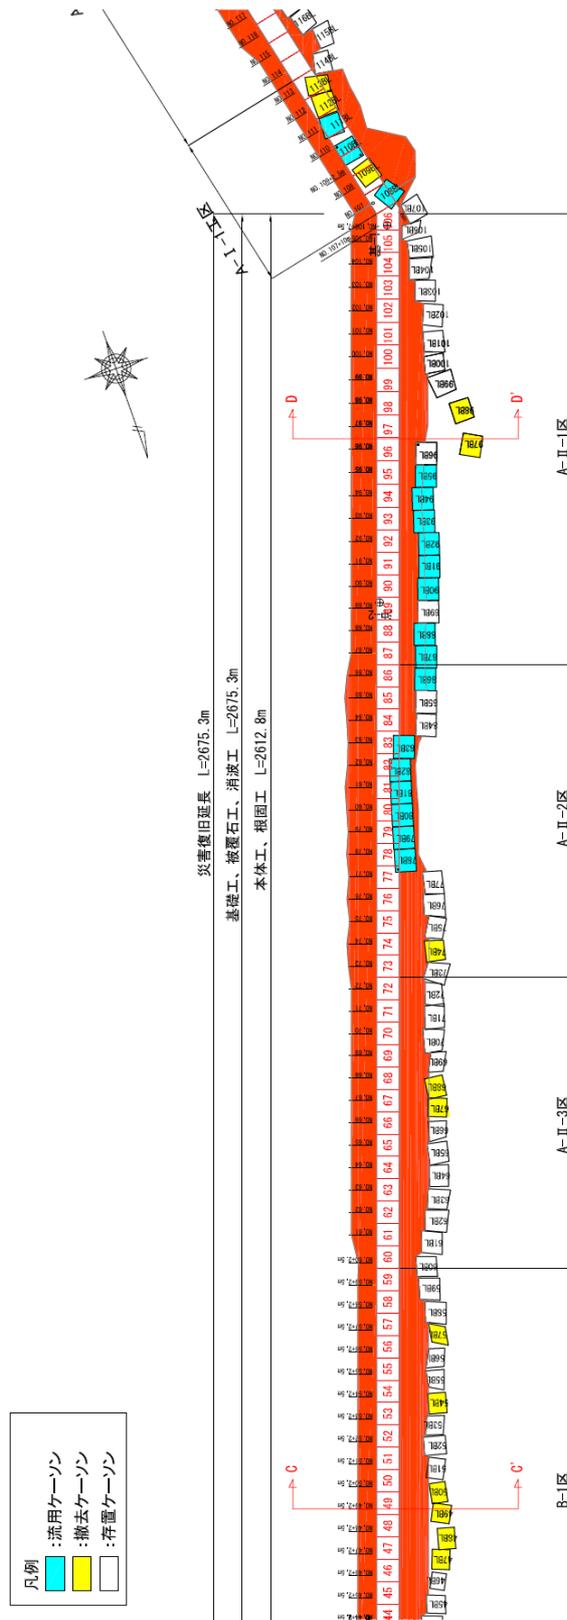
No.1 沖防波堤の平面図 A-II-1 区～B-1 区（被災後・復旧後）
